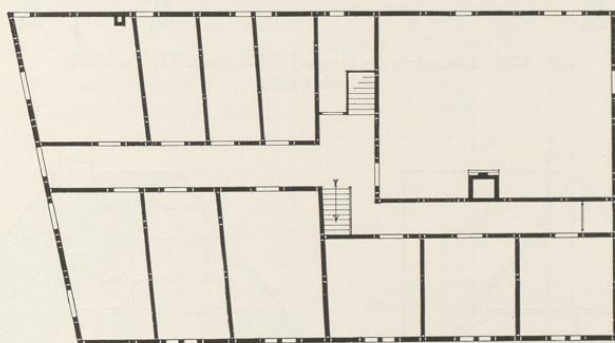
Grundriß des Obergeschosses des Hauses Jüdefelderstraße 29
